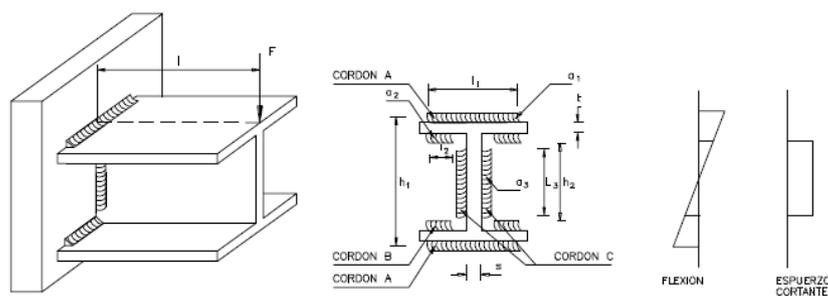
Detalle de las soldaduras de la placa de anclaje
